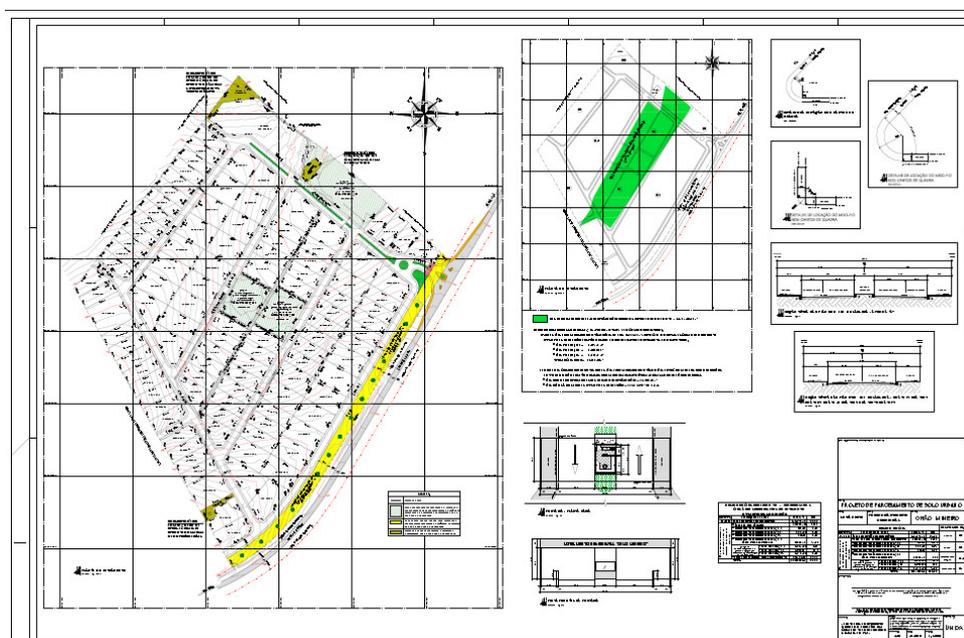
Planta do Empreendimento ilustrando as áreas de intervenção. Fonte: PECF 2017
